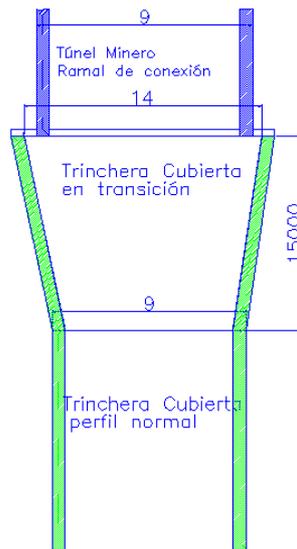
Planta de Transición de Túnel a Sección de Trinchera Simple
